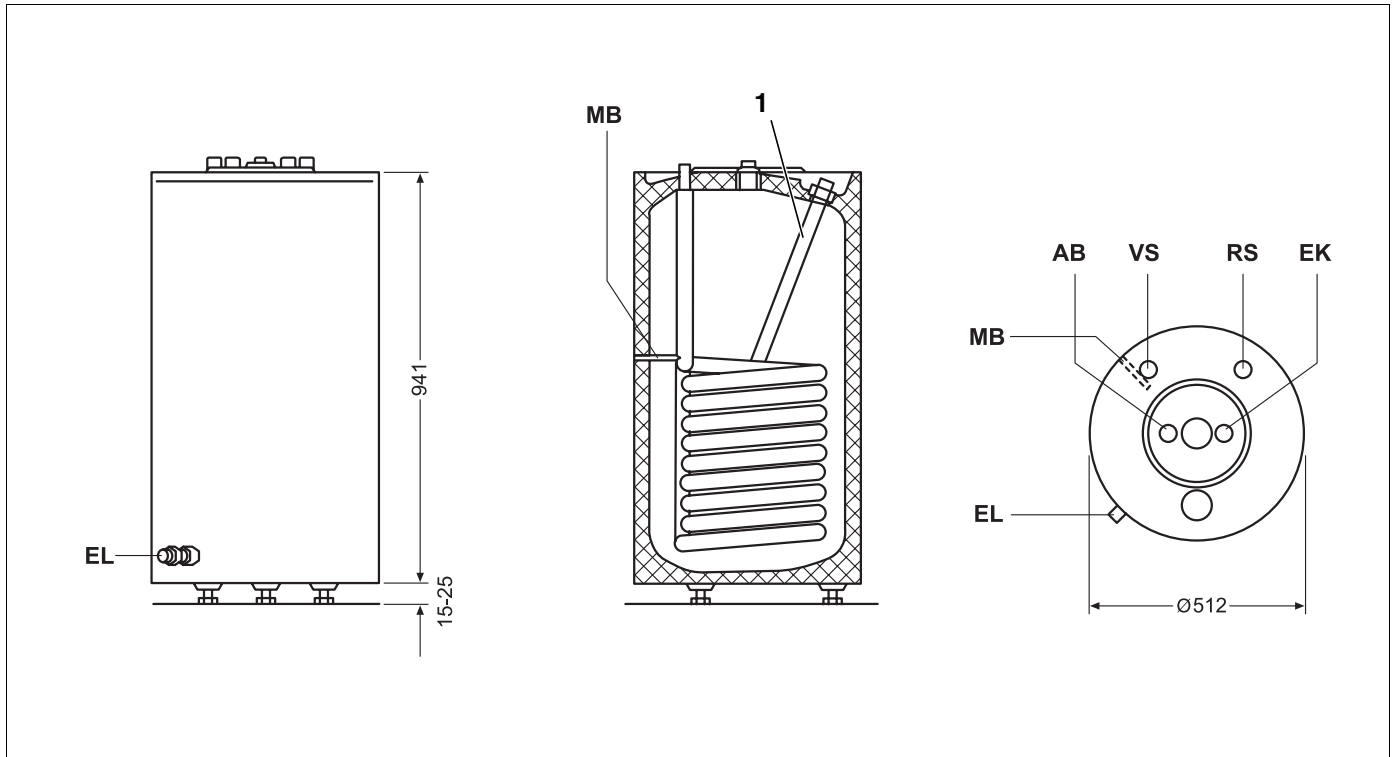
Abmessungen und Anschlüsse (Maße in mm)
